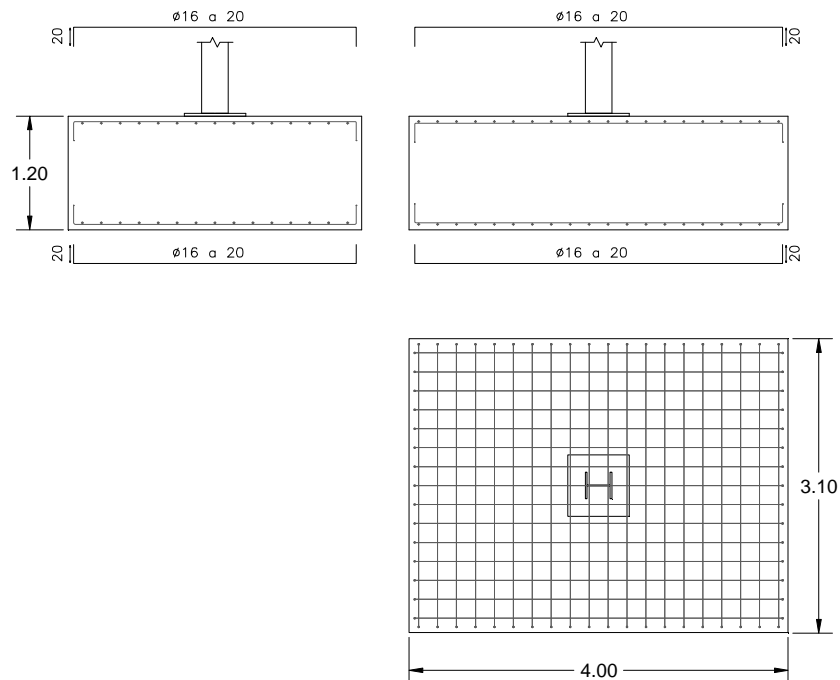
Esquema de l'armat de la sabata sota el pilar N157
